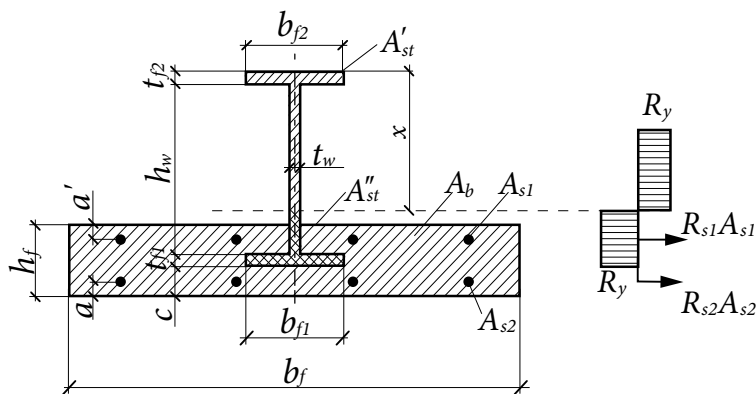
Случай, когда нейтральная ось пересекает стенку стального профиля жесткой арматуры в комбинированной балке с опиранием железобетонной плиты на нижний пояс
